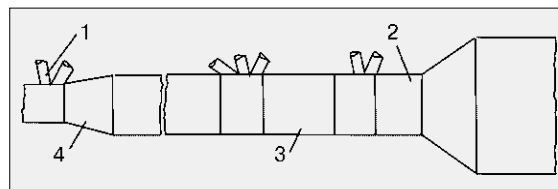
Расположение завершающих сварных швов между трубчатыми и узловыми секциями: 1 — узловы секции; 2 — завершающие сварные швы; 3 — трубчатая опора (между узлами); 4 — конусные секции
